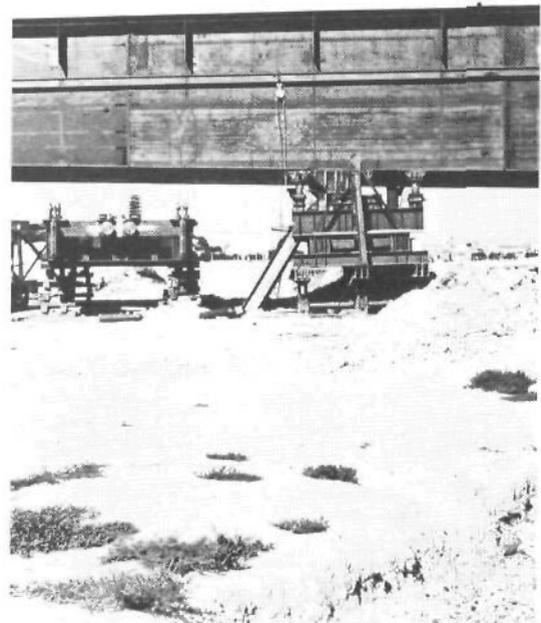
Palée provisoire avec semelle en béton, reposant sur un terrain de mauvaise qualité. Le lancement du tronçon est effectué de la droite vers la gauche. Des tassements se sont produits, ce qui explique la présence de l'étaie placée à gauche de la palée.
